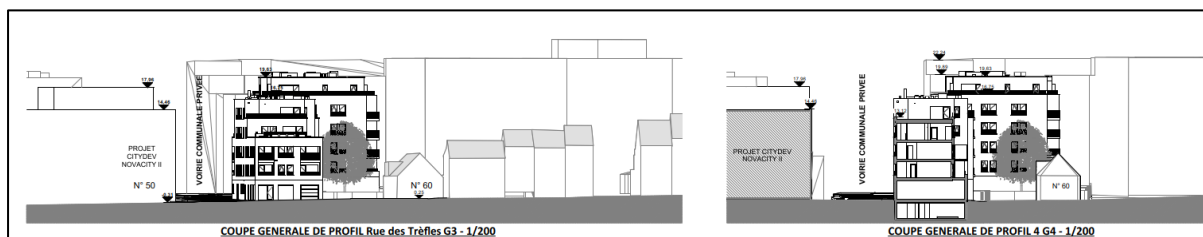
Coupe générale de profile G3 et G4 - 1/200 (source : Plans PU)
